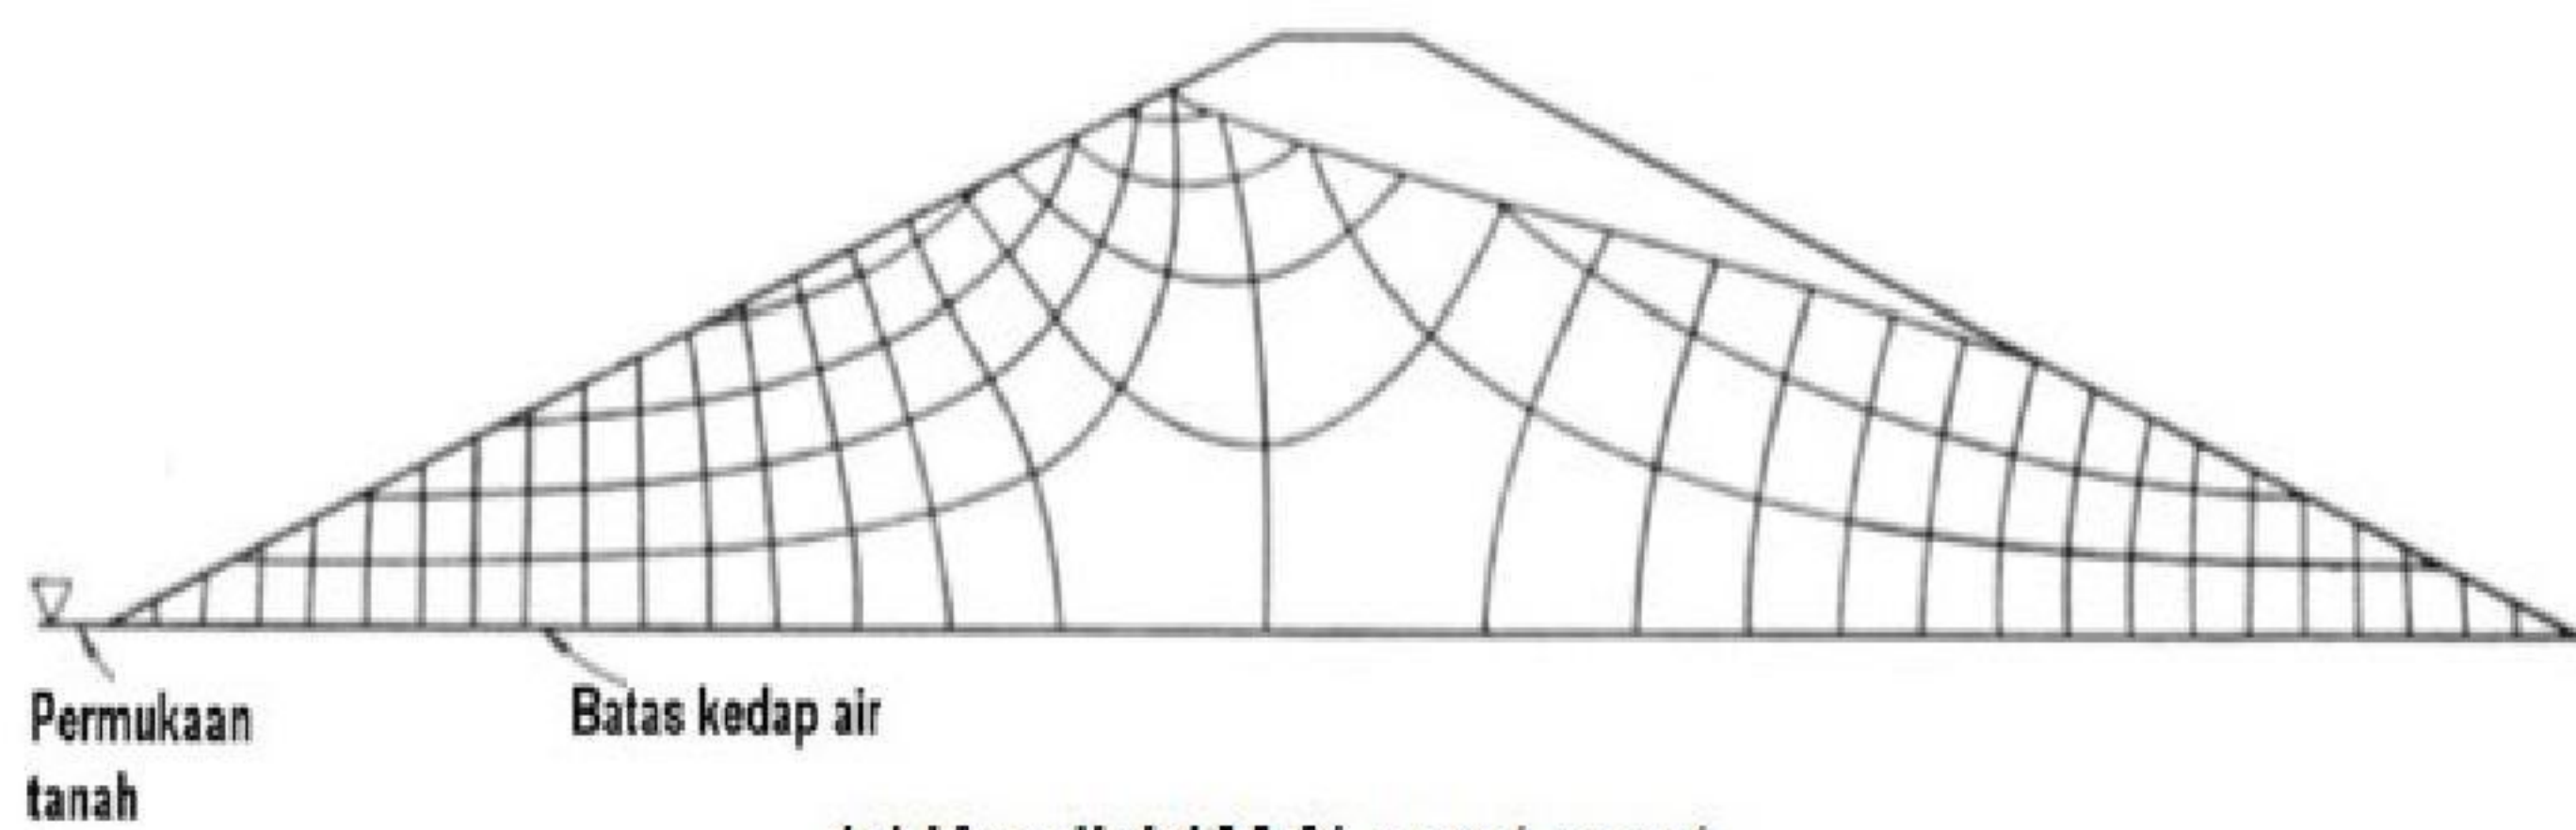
Rembesan melalui tubuh bendungan dan fondasi
